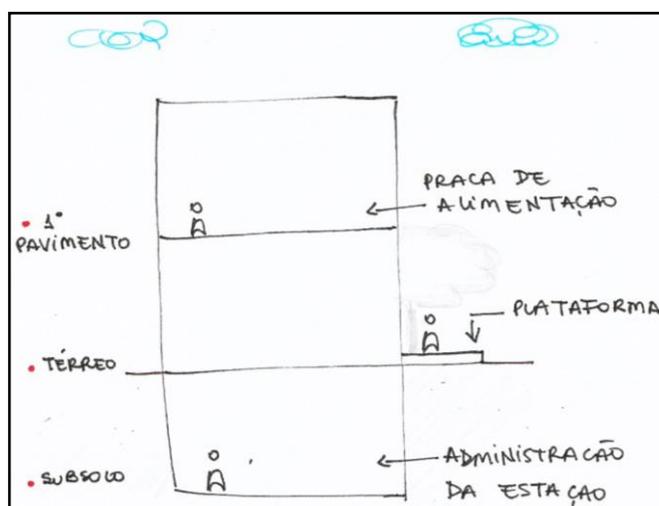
Croqui do esquema de pavimentos da estação de trem Fonte: Produzido pela autora
